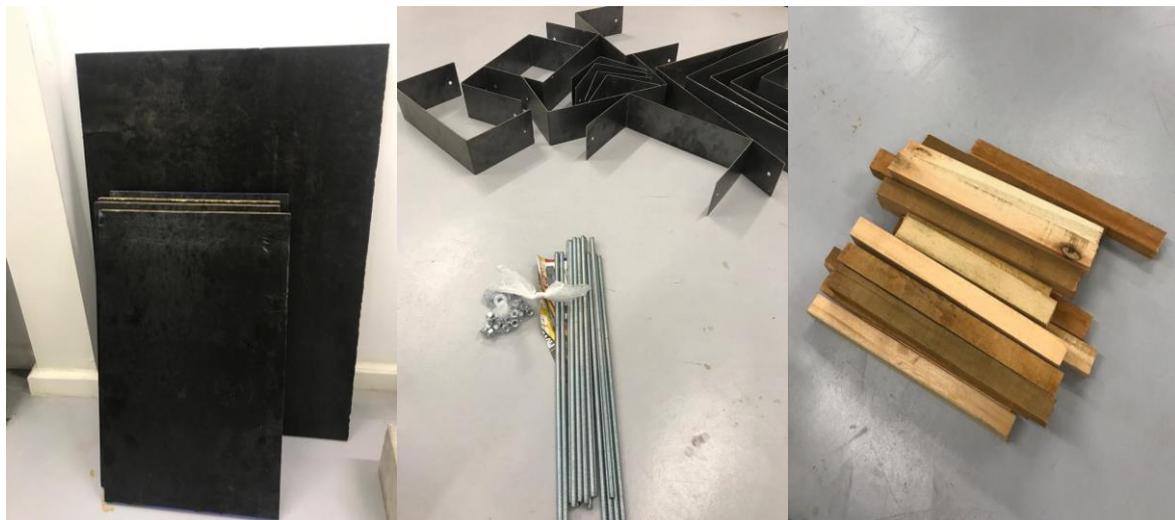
Componentes da fôrma: placas de madeirite, peças metálicas e vergalhões e caibros
